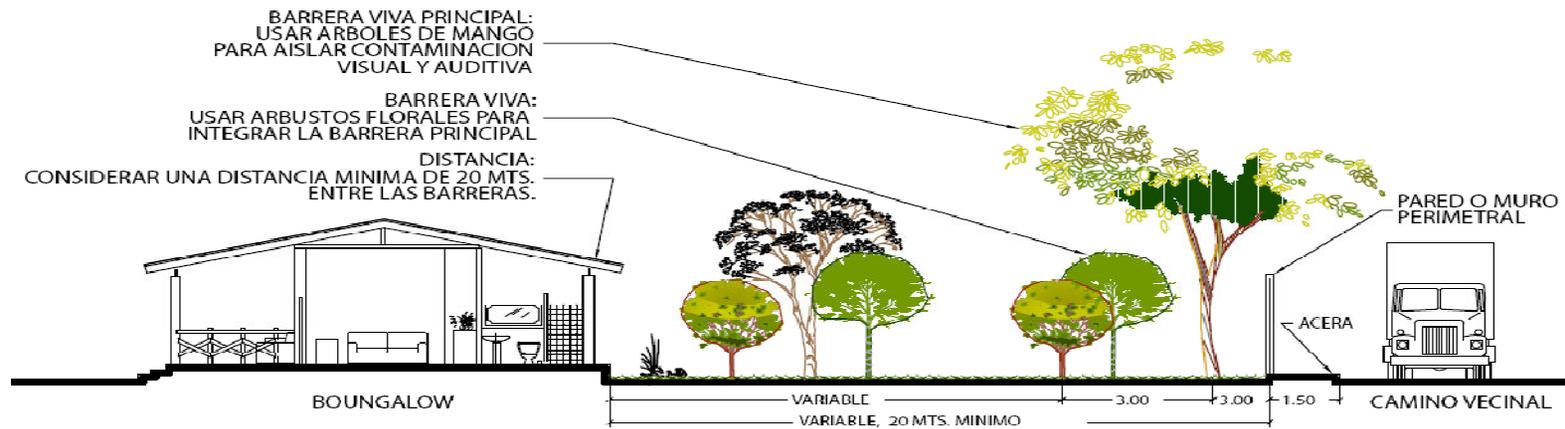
Detalle de barrera física a utilizar para aislar visual y auditivamente las áreas en donde sea necesario.
